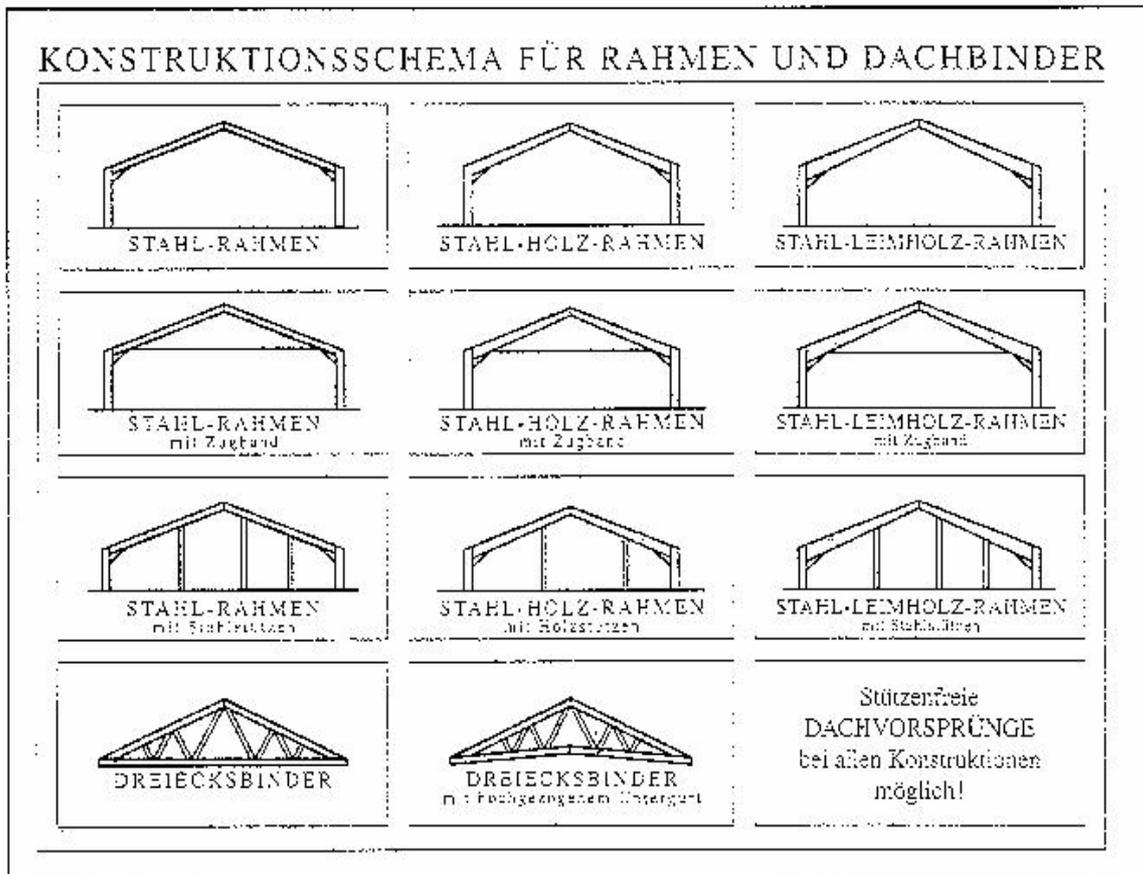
Konstruktionsschema für Rahmen und Dachbinder
